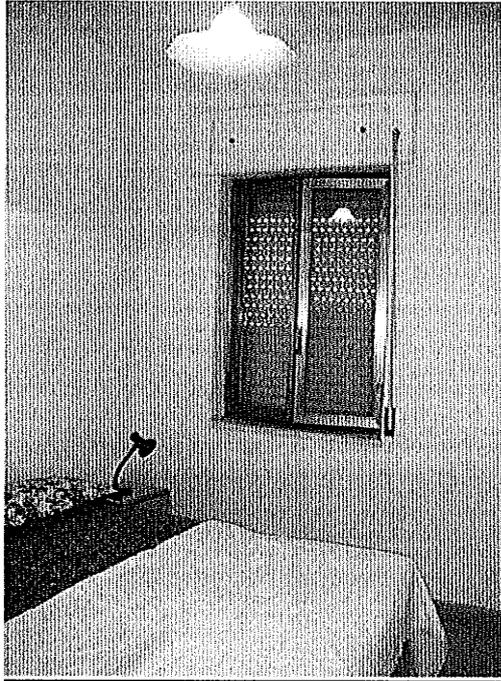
Particolare Camera da Letto 1 appartamento ubicato al piano secondo
